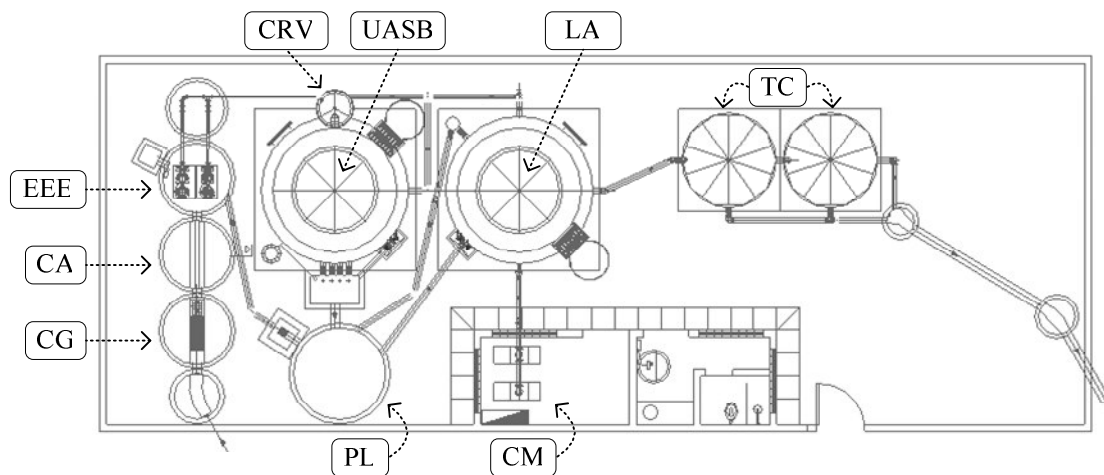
Planta baixa da estação de tratamento de esgoto do HGWA.
